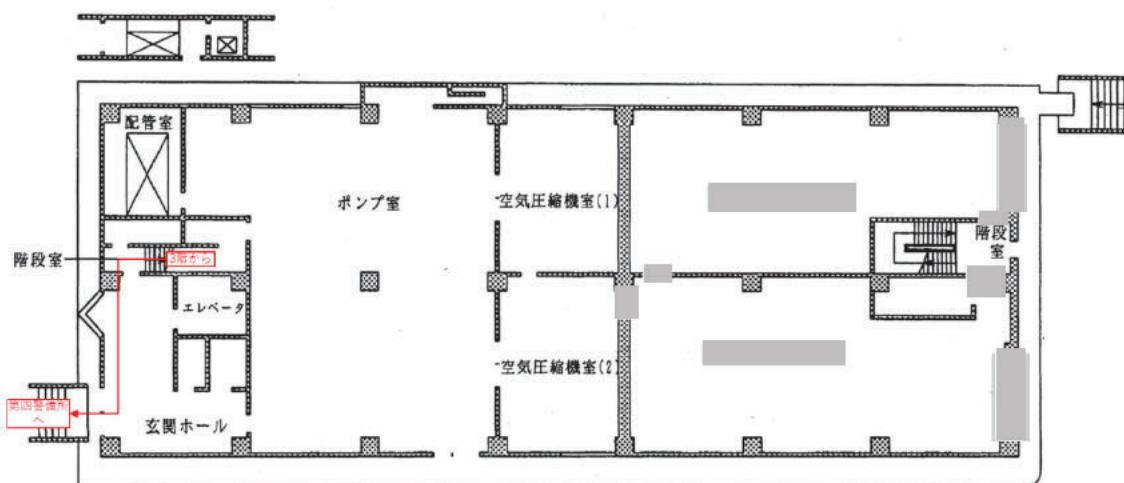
(2) 移動経路（ユーティリティ施設 地上 1F 平面図）
